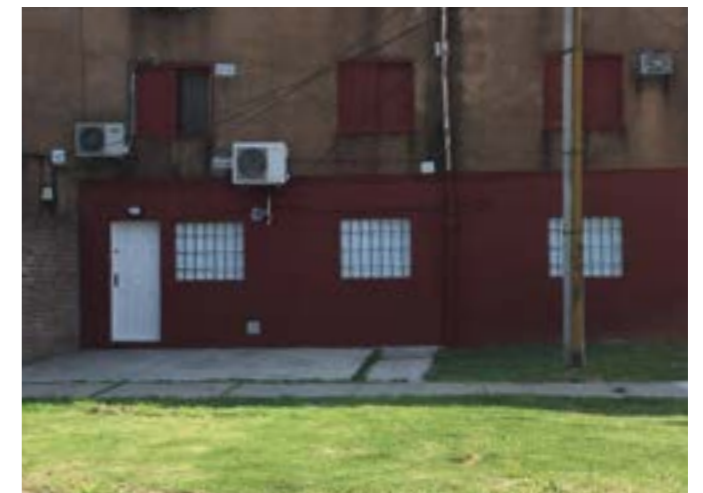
Imágenes carpinterías fachada mono-block y espacios de trabajo con acceso directo. Fotos: fotografías de la autora.
